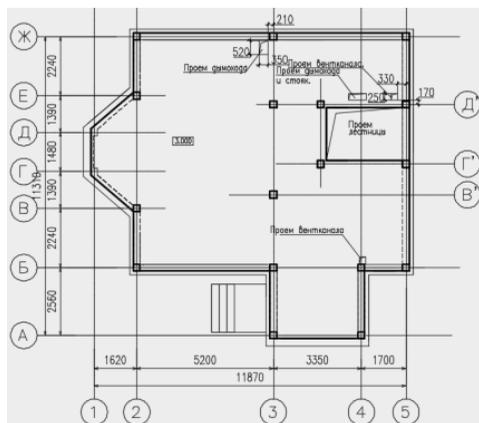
План монолитной ж/б плиты перекрытия 2-го этажа
